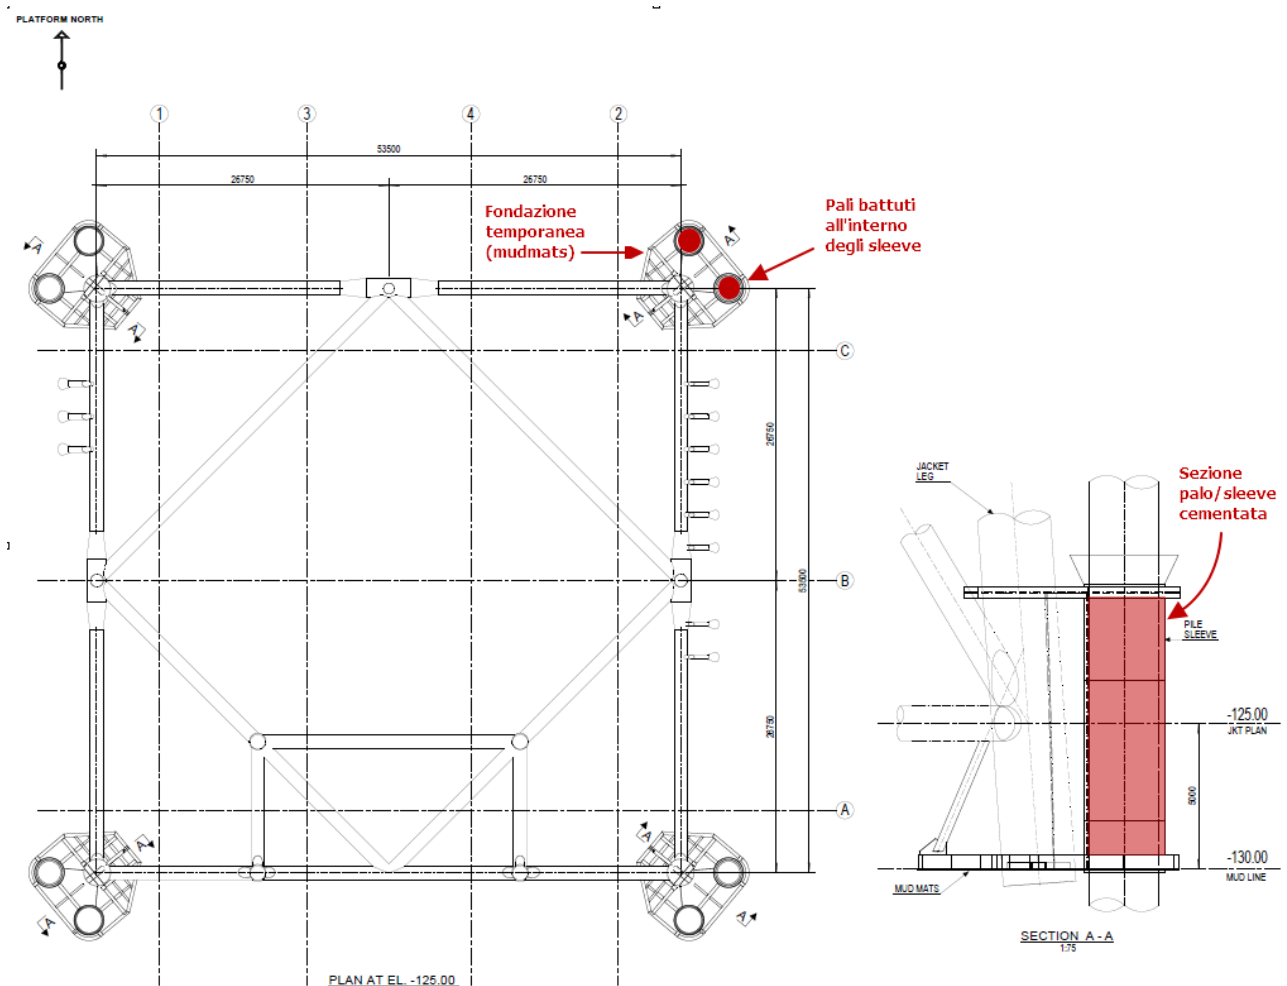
Sottostazione 1 sezione orizzontale in prossimità del fondale/sezione verticale connessione al palo
